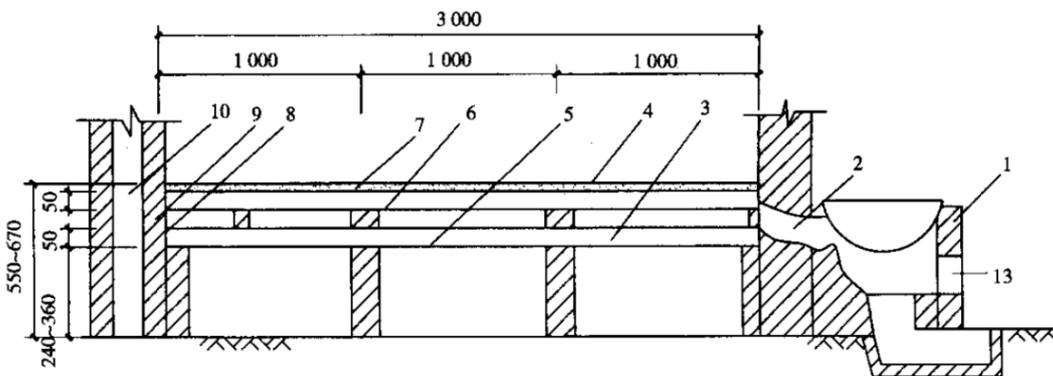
高效预制架空炕连灶纵剖面图
